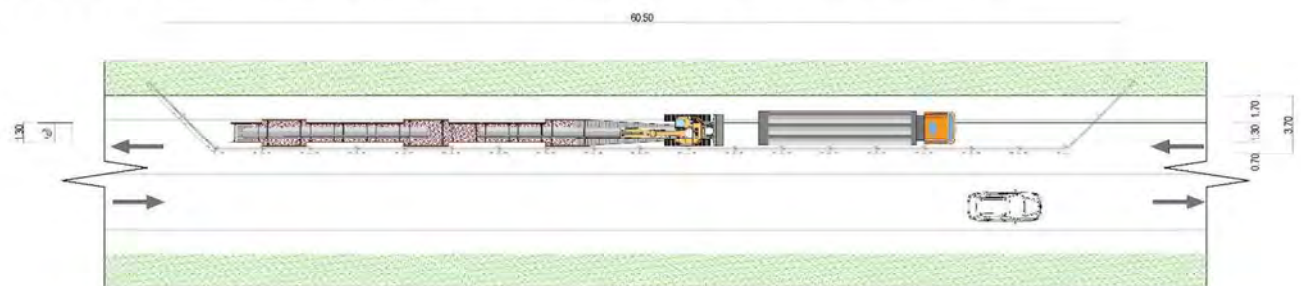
Pianta tipo posa condotte su strada Fase posa condotte
